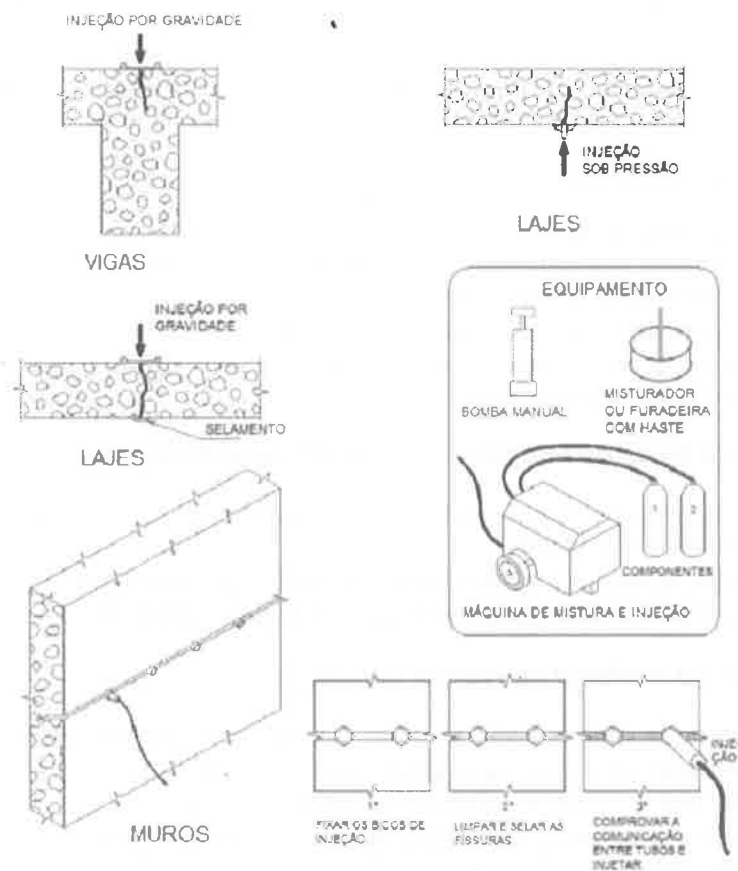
Injeção de fissuras e trincas.
